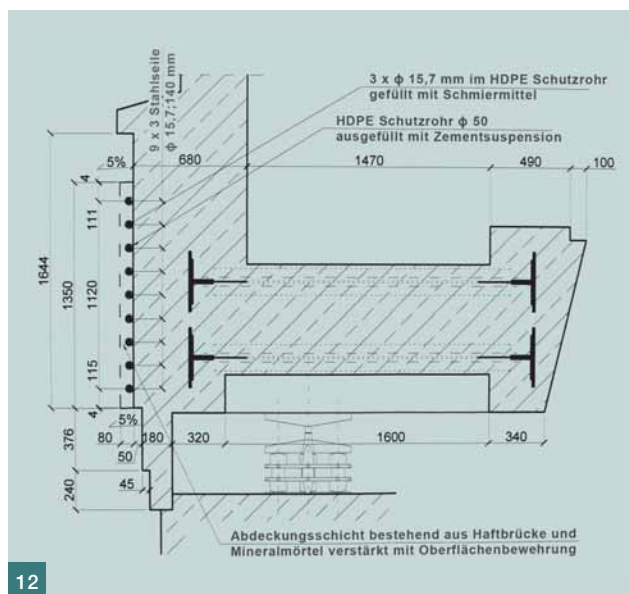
Zajištění patního věnce pomocí vnějších předpínacích prvků a povrchové betonářské výztuže ■ Fig. 13 Securing of the foot ring beam by means of external prestressing elements and surface concreting reinforcement
